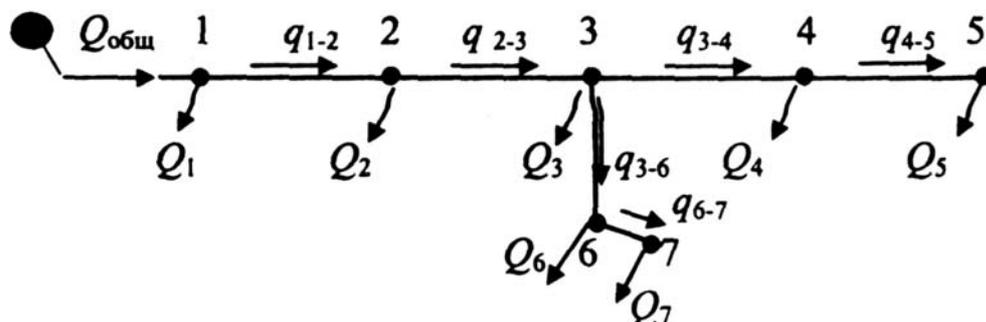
Расчетная схема разветвленной водопроводной сети
